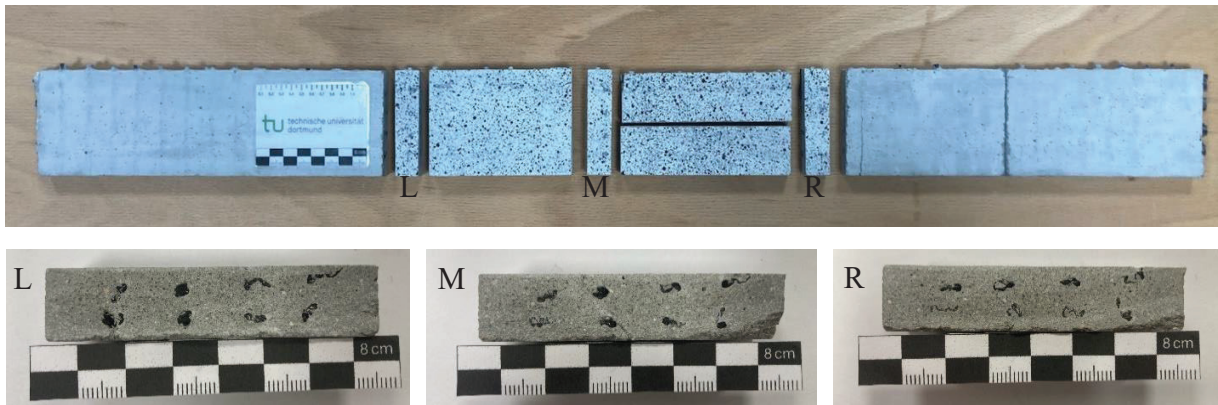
Probenzuschnitt für mikroskopische Aufnahmen: Dehnkörperprobe mit Zuschnitt der Einzelproben (oben), Querschnitt linke Probe (L), Querschnitte mittlere Probe (M), Querschnitt rechte Probe (R)
